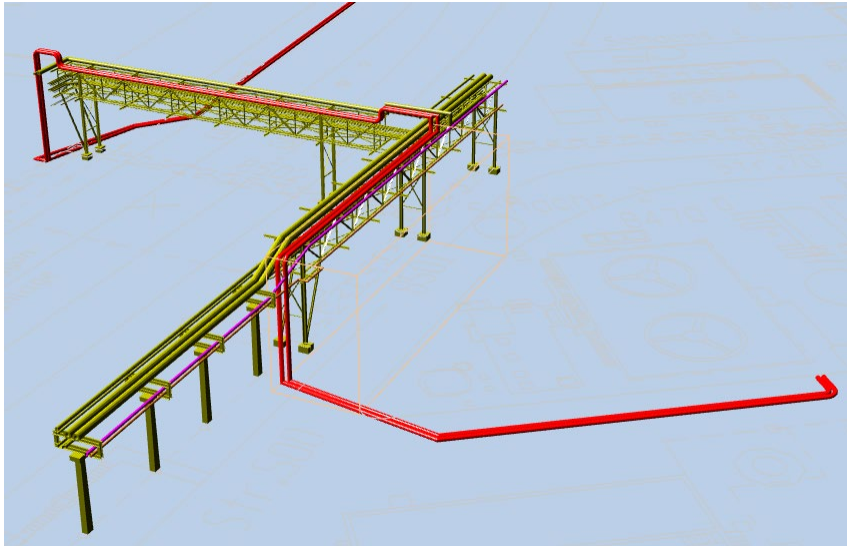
Ursprünglich geplanter Rohrleitungsverlauf Abwärmetrasse
